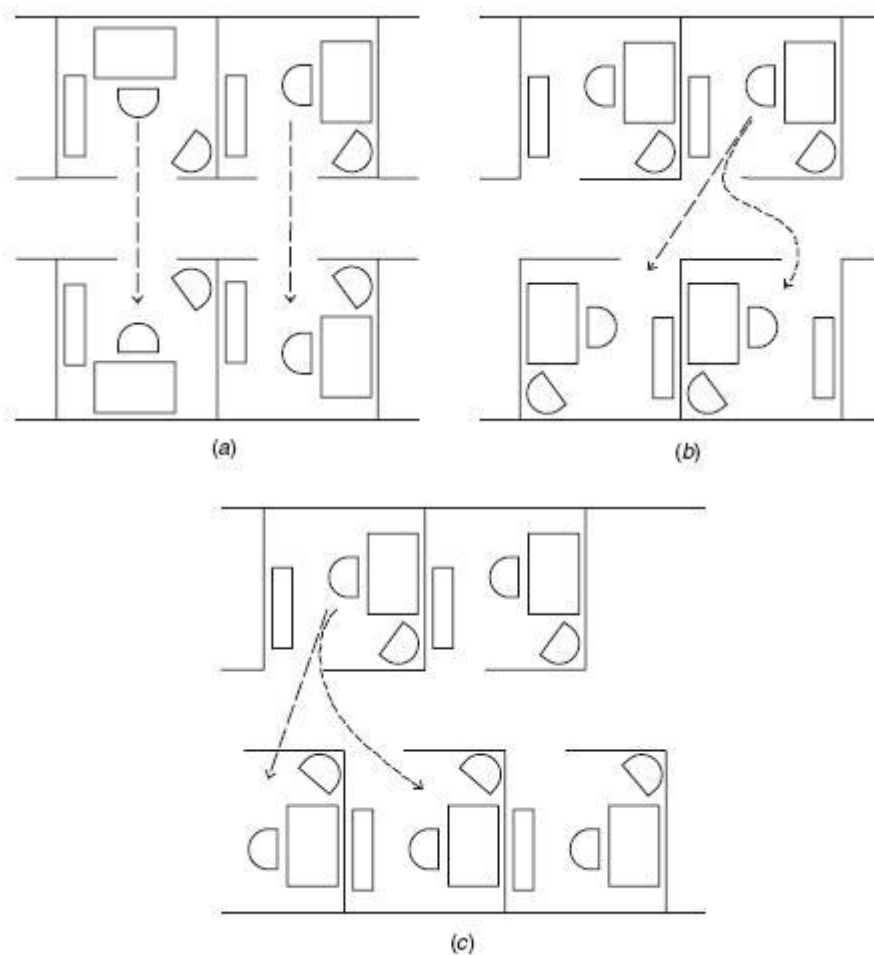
Configurações de espaços *open plan*. (a) – pobre configuração; (b) – média configuração; (c) – boa configuração [37].
